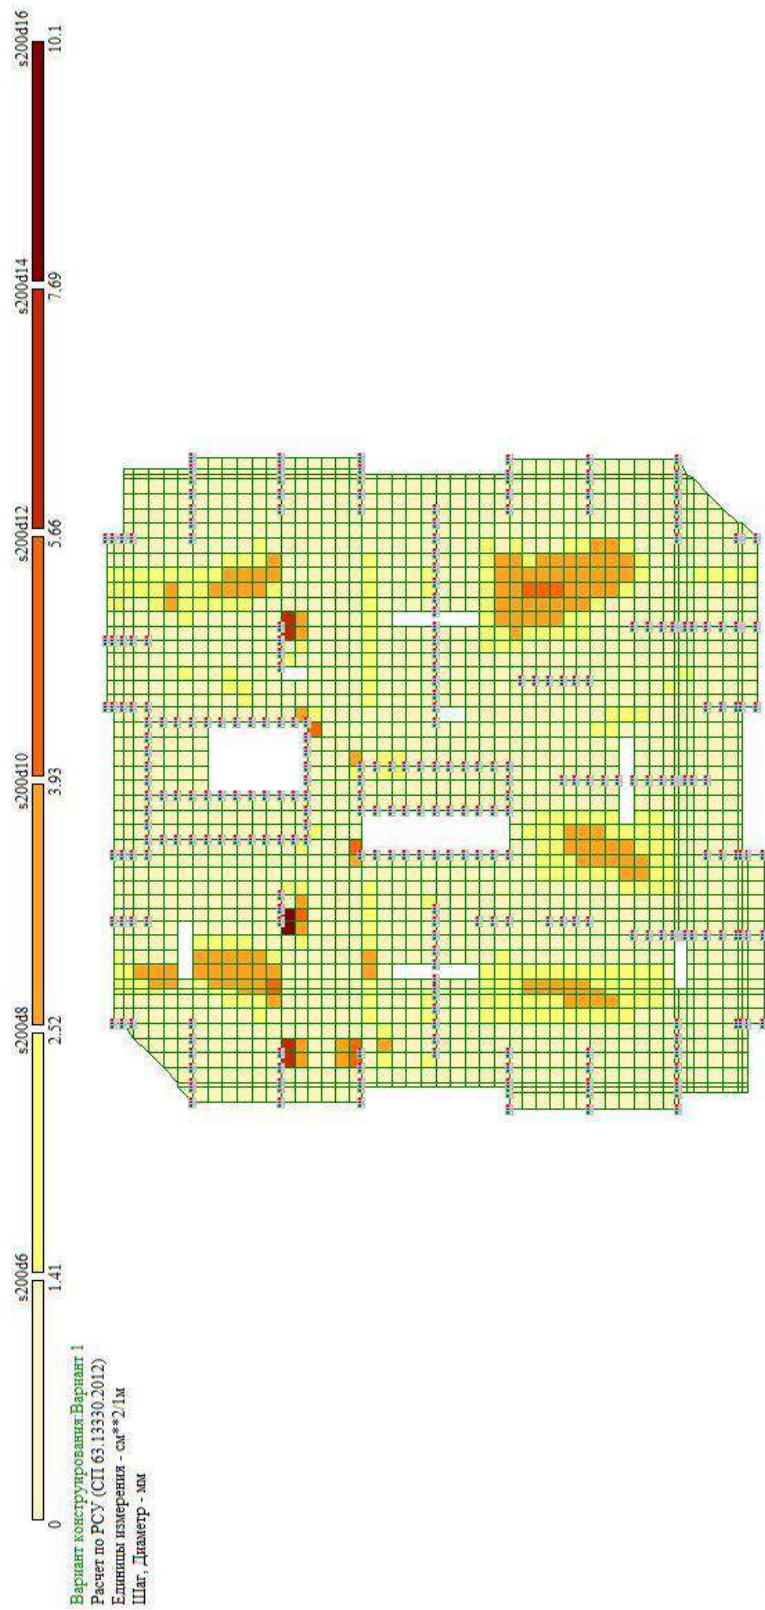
Площадь армирования по оси X у нижней грани.
